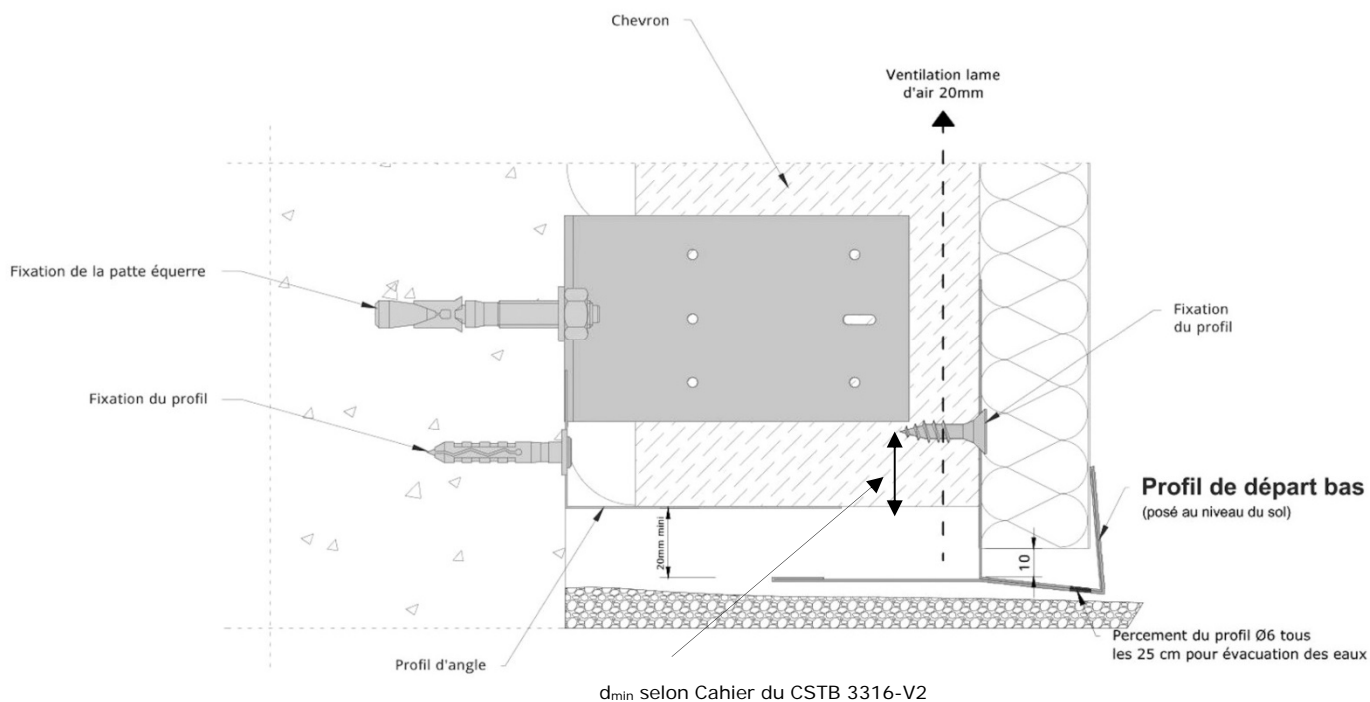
1 - Bas de façade – Pose en bardage rapporté (coupe verticale)
